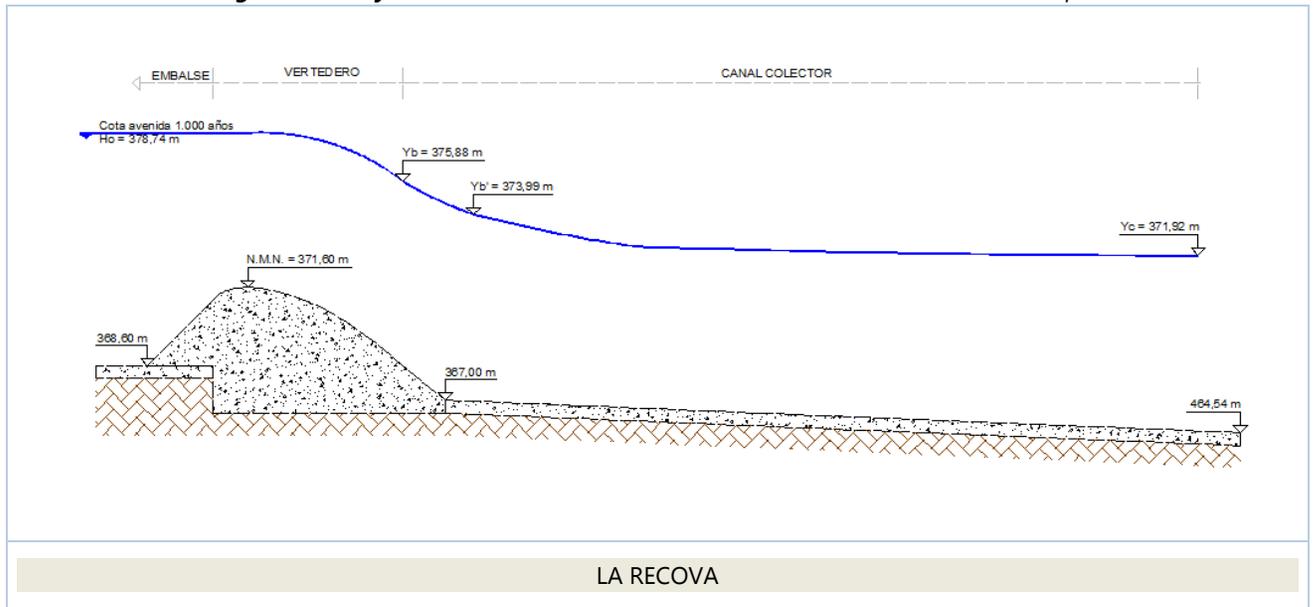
Eje hidráulico canal colector. Fuente: Elaboración Propia
